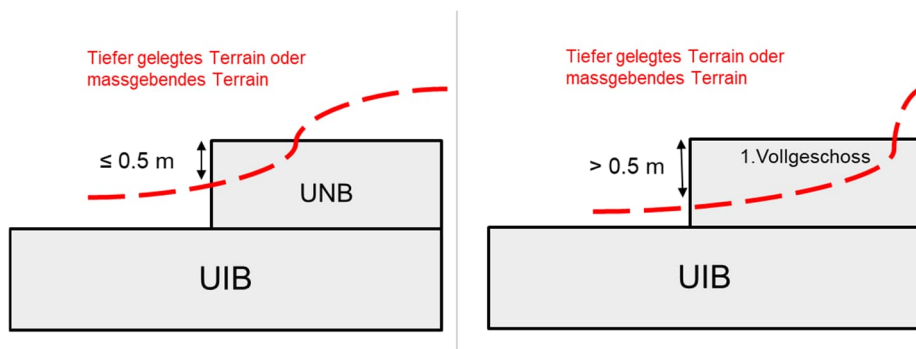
Unterirdische Baute (UIB) und Unterscheidung Unterniveaubaute (UNB)
